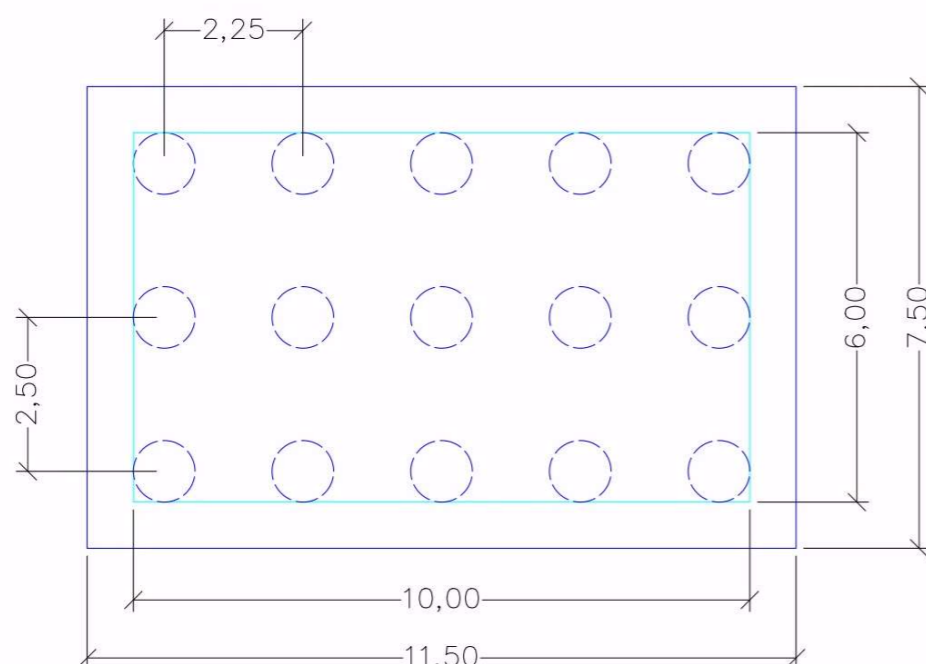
Dimensiones y disposición de los pilotes de la cimentación del estribo 2 en planta, en metros.
